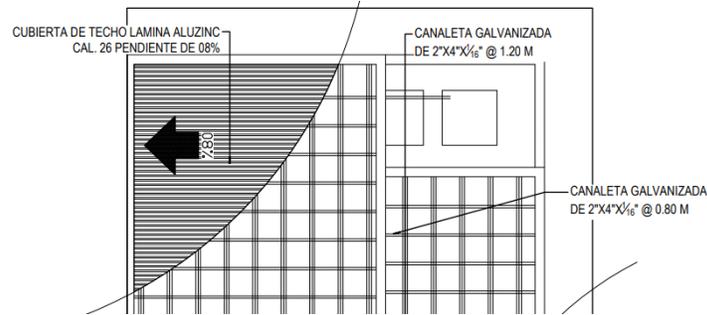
Planta de techo con lamina aluzinc y canaleta galvanizada.
